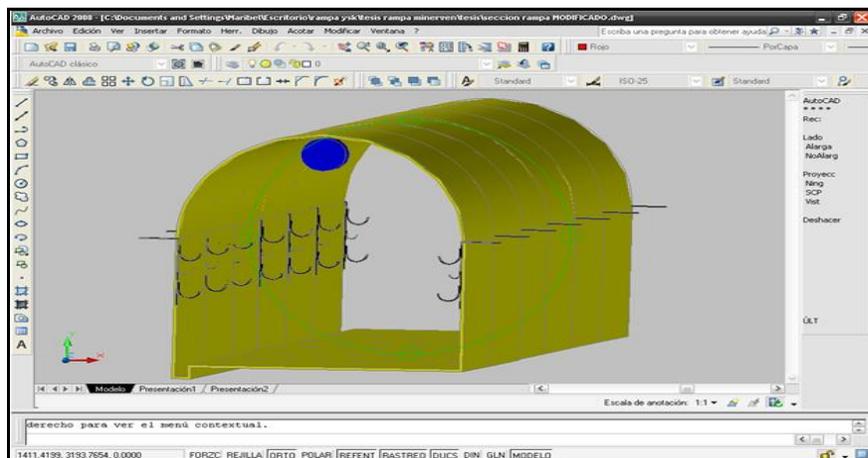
Vista en órbita libre del diseño del sistema de anclaje de tuberías, mangueras y cables.
